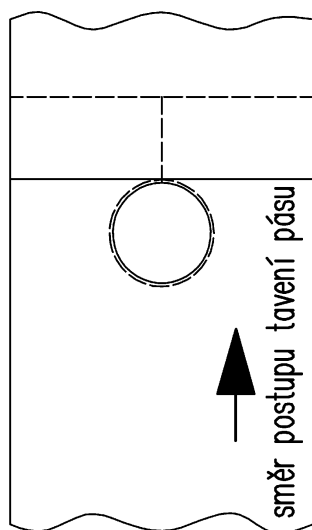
/ Schéma opracování detailu kruhového prostupu
